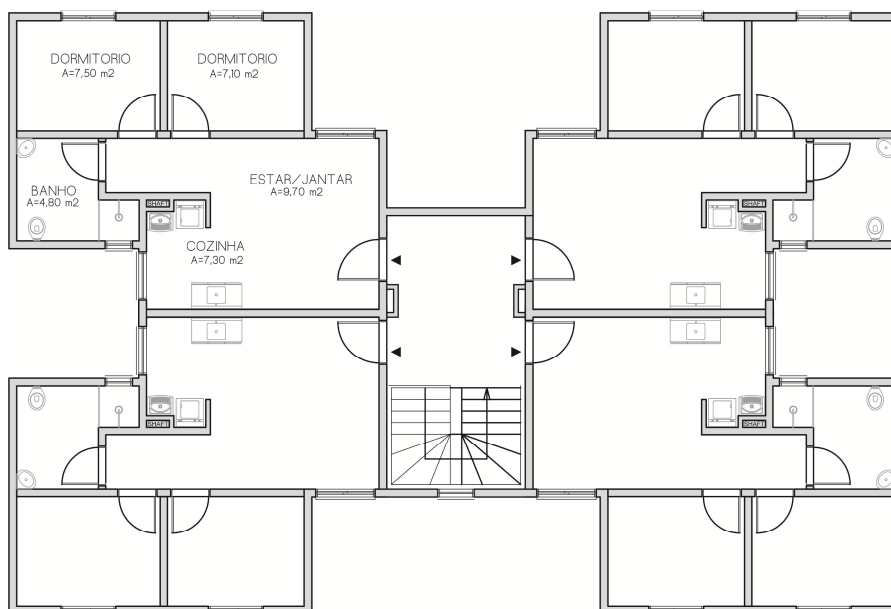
Planta baixa do Projeto-base (escala indeterminada).
